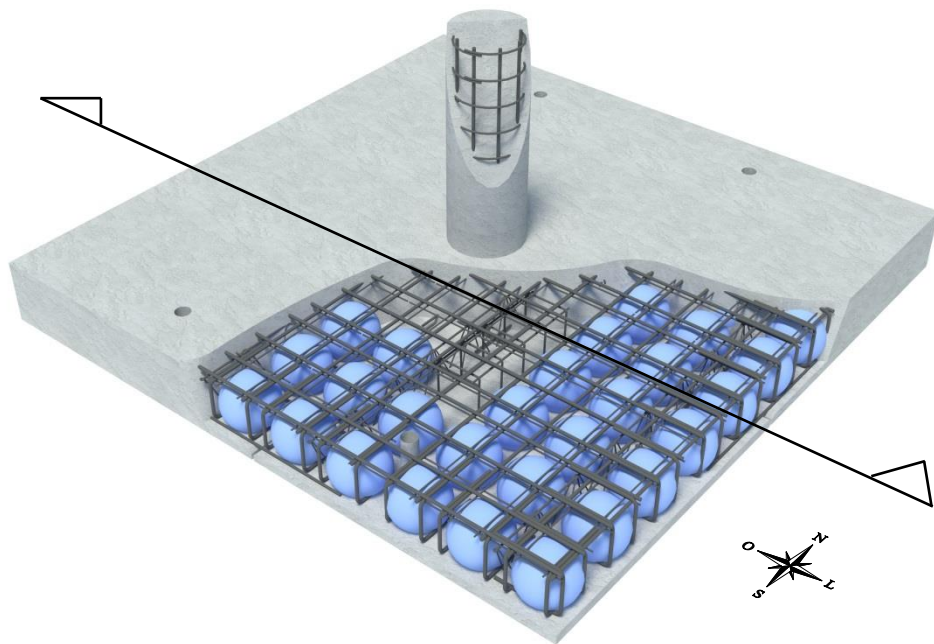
Perspectiva da laje BD2 entreaberta
